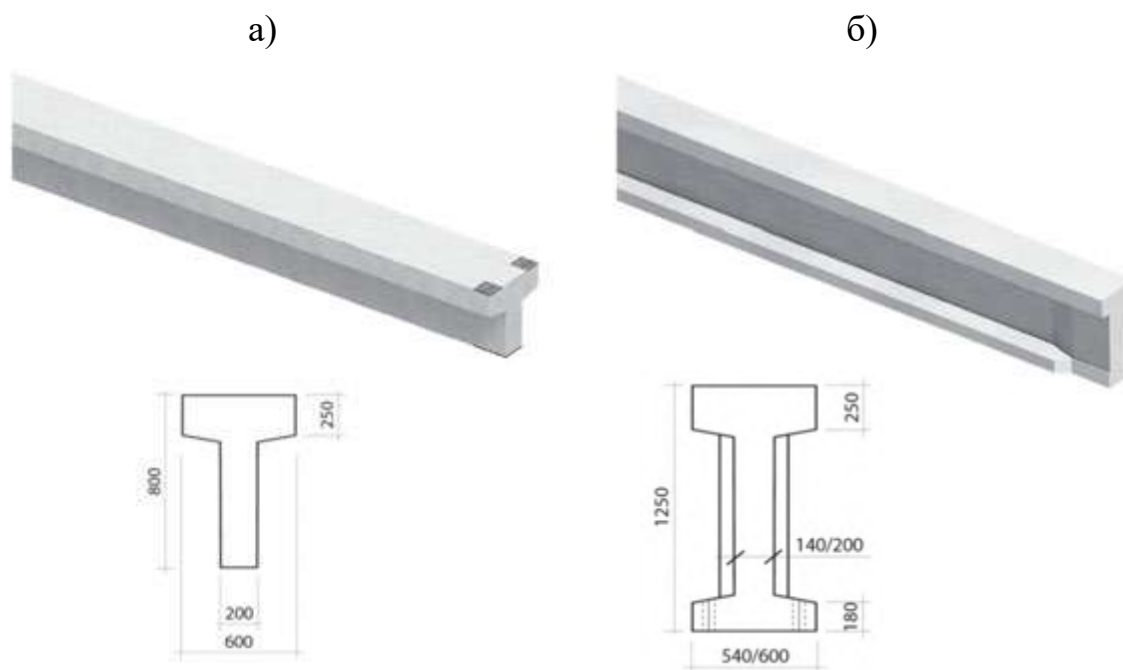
Збірні залізобетонні підкранові балки: *a* – прогоном 6,0 м (таврового перетину); *б* – прогоном 12,0 м (двотаврового перетину)
